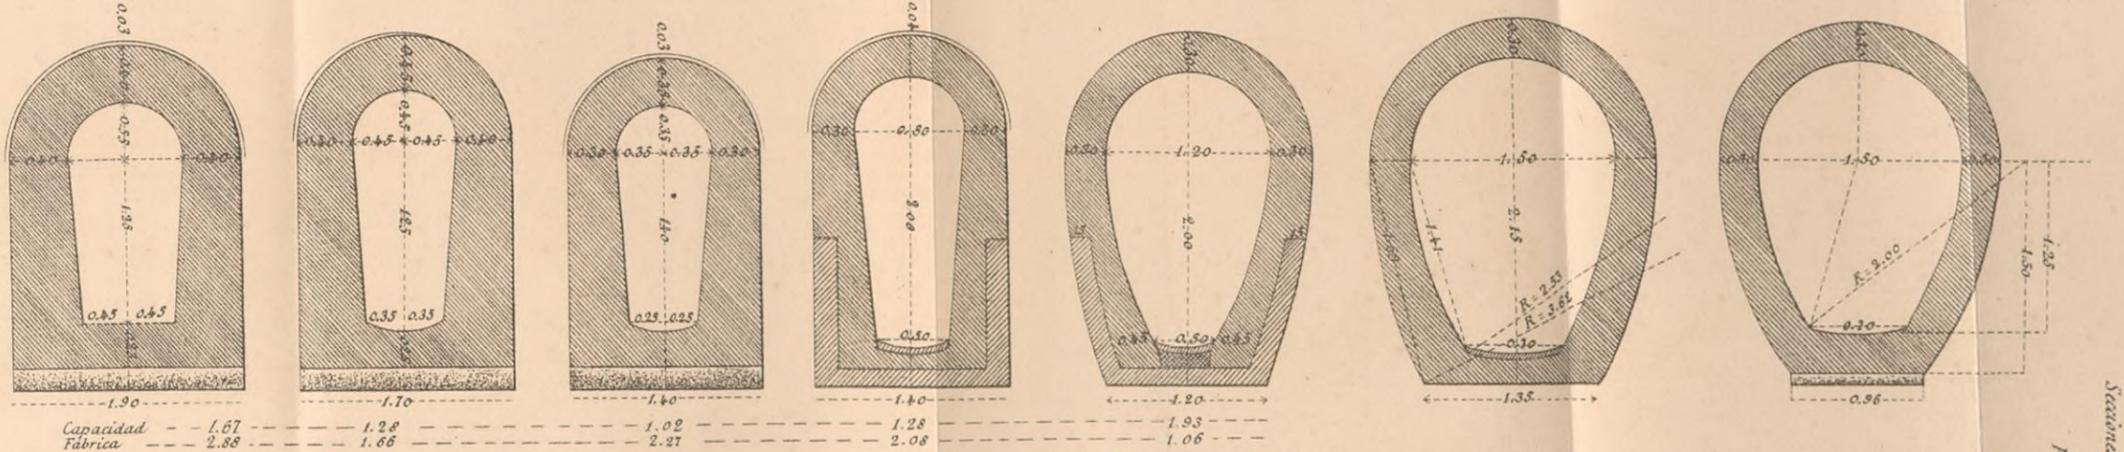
Alcantarillas en Betun de Cimento.
